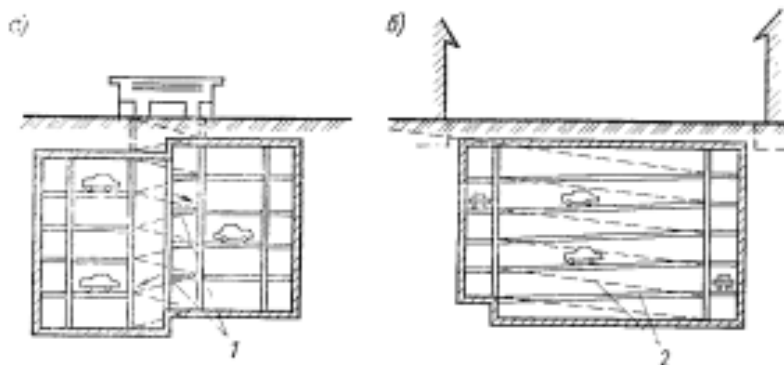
Схеми підземних гаражів з напіврампами (а) та похилими перекриттями(б): 1 напіврампи; 2- похилі перекриття
